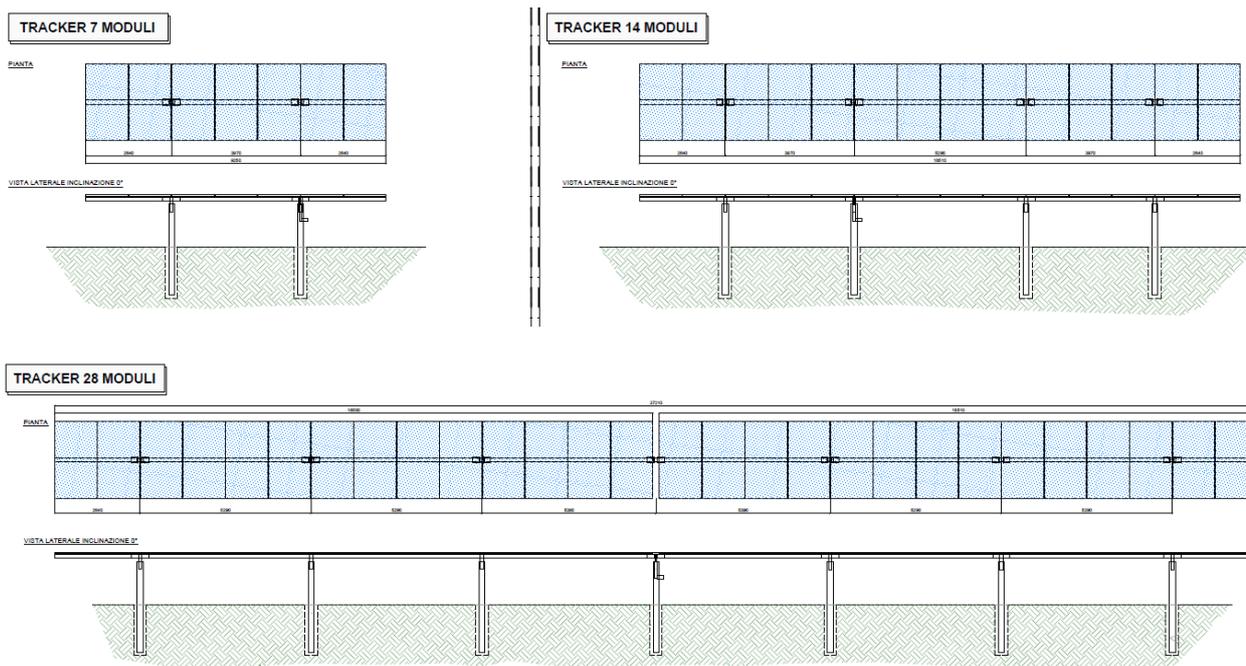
Tracker da 7/14 e 28 moduli. Pianta e viste da elaborati di progetto.
